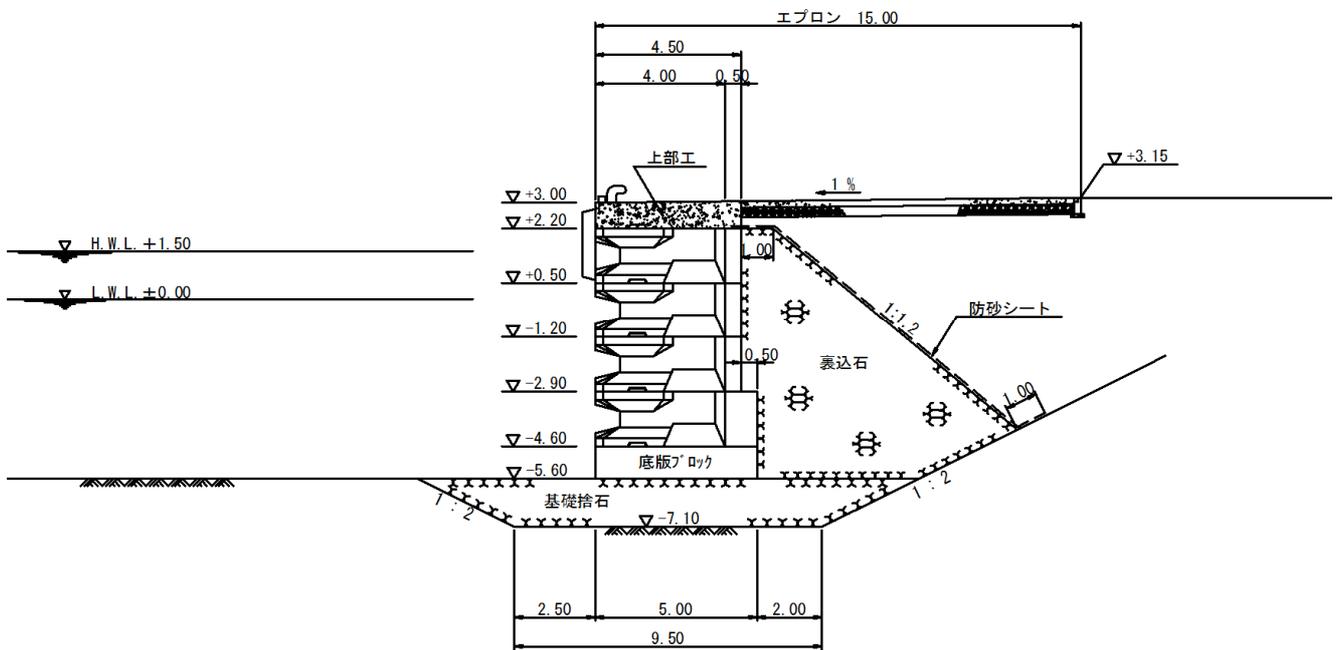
245 No.22 常陸那珂港区_南埠頭地区 B岸壁 (-5.5m) の断面図 (被災前)
